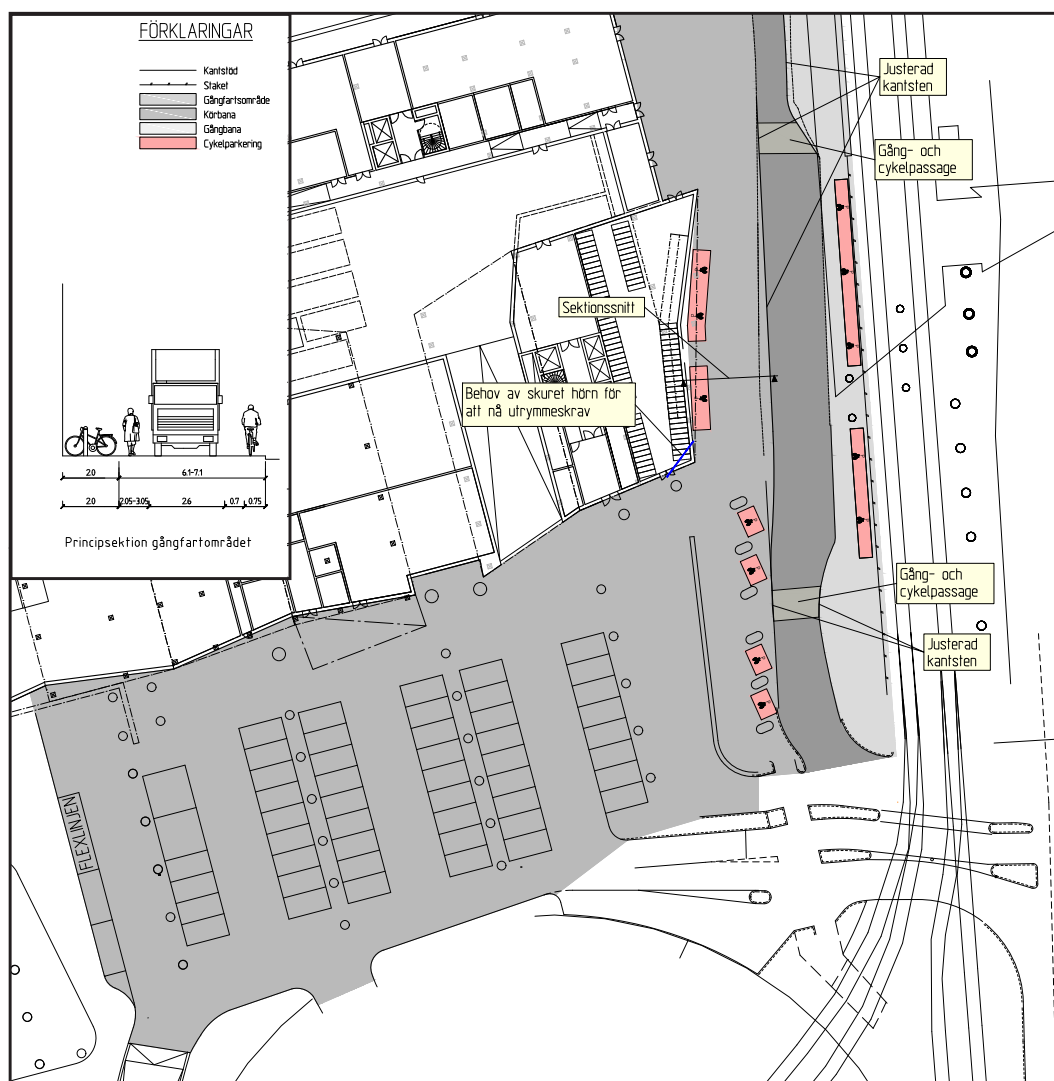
Trafikförslag nedre plan (se även bilaga 3)
